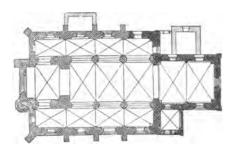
Brandshagen. Kirche. Grundriss. 1:667.
